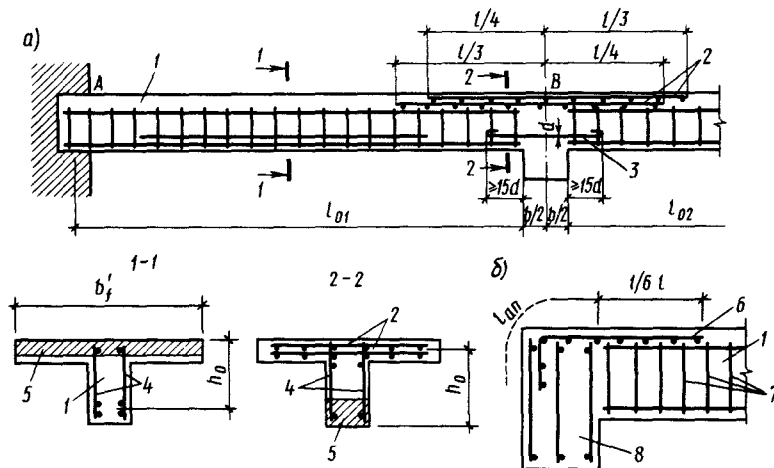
Конструкция второстепенной балки: 1 — второстепенная балка; 2 — надопорные сетки; 3 — стыковой стержень; 4 — пролетные каркасы балок; 5 — сжатая зона бетона; 6 — конструктивная схема над крайней опорой балки; 7 — поперечные стержни
